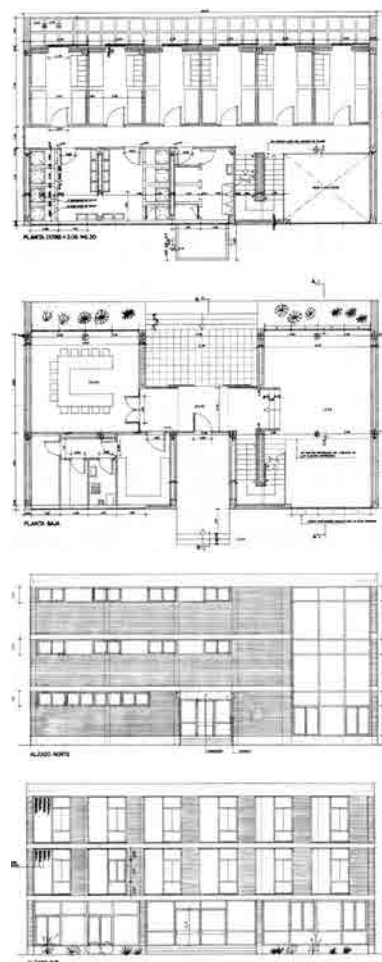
, Fig. 36, Fig. 37 y Fig. 38 Residencias. De arriba a abajo: planta tipo, planta baja, alzado Norte y alzado Sur.
